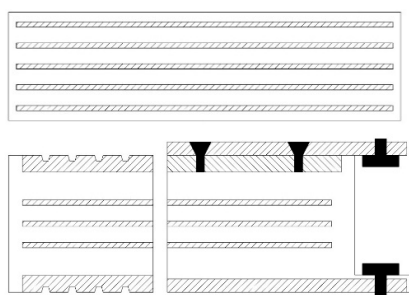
Arriba: apoyo tipo B; abajo: apoyo tipo C
